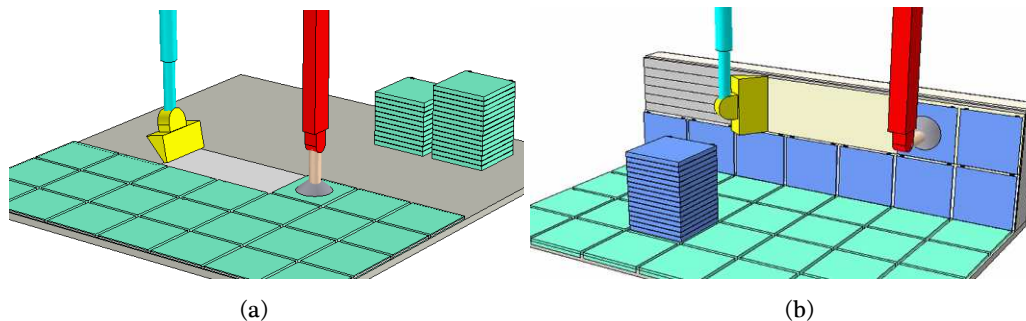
Sistema automatizado para la colocación del solado y del aplacado de las paredes. Fuente: Contour Crafting.
